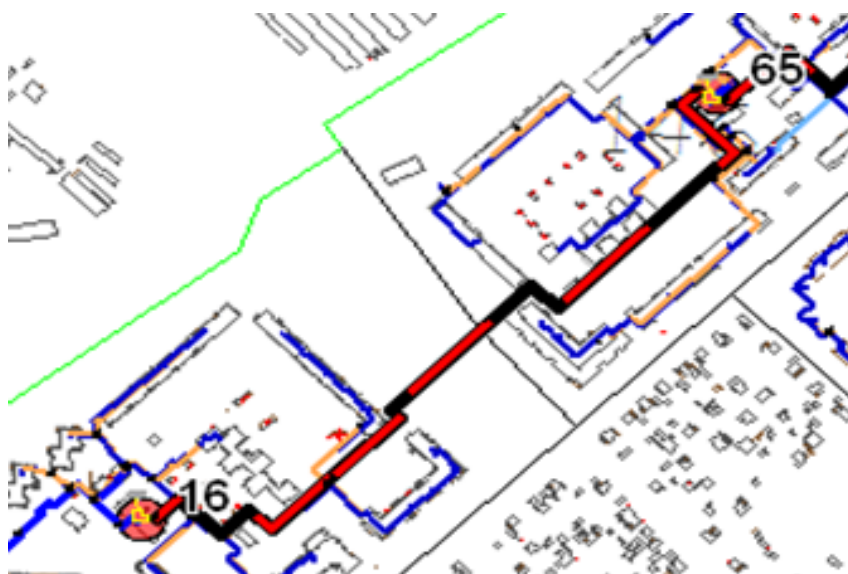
Схема прокладки трубопровода между котельными №65 и №16
